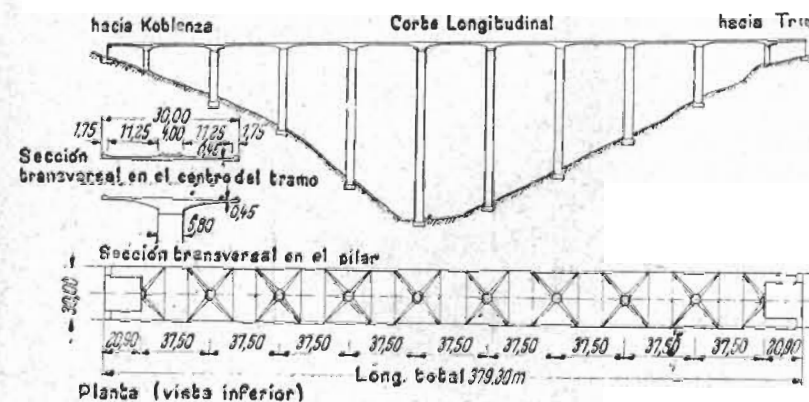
Puente en el valle del Elz, autovía Montabaur - Koblenza - Trier; corte longitudinal, planta y sección transversal
